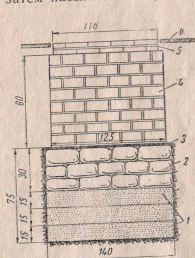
Сплошной фундамент на песчаной или гравийной подушке:
